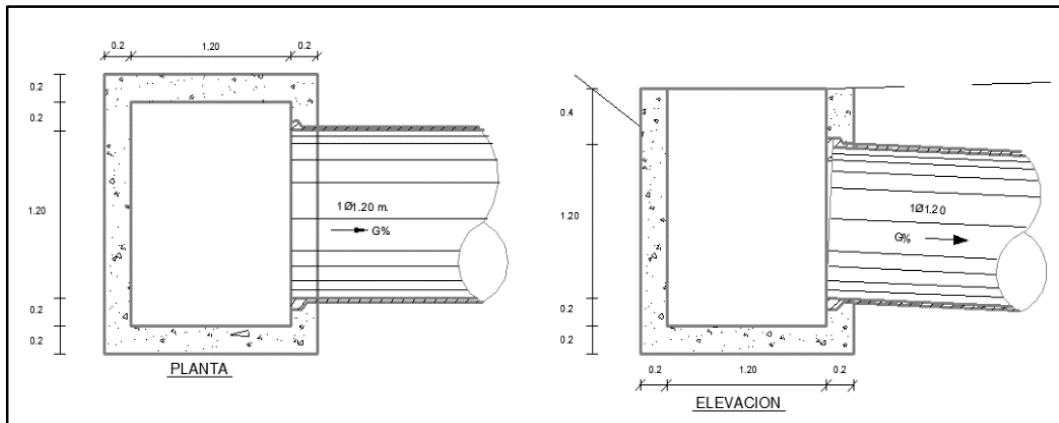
Cabezales de entrada en planta y elevación – alcantarillas tipo.
